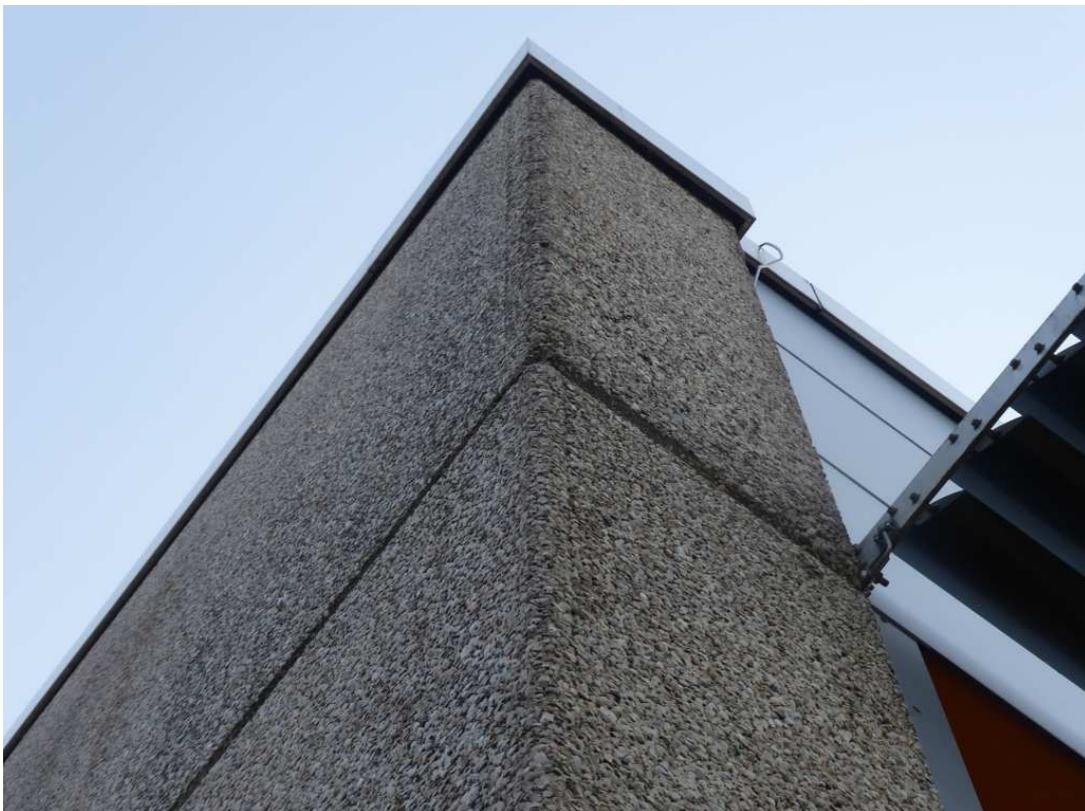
Ecke eines Gebäudes mit Spalte am Anschluss des Flachdachs
